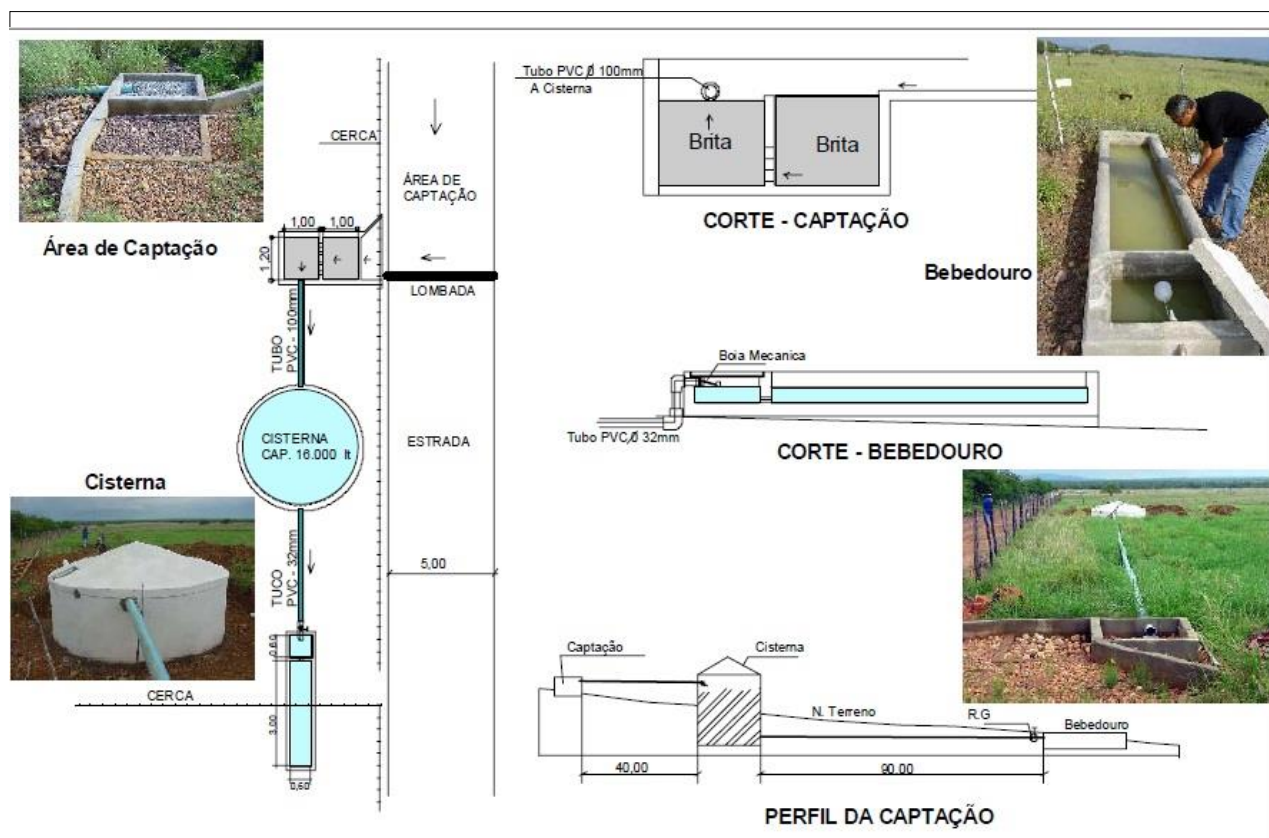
Planta baixa do sistema contendo a área de captação, o sistema de filtragem, a cisterna e o bebedouro dos animais. Foto: Arquivo de Imagens da Embrapa Semiárido (2007)
